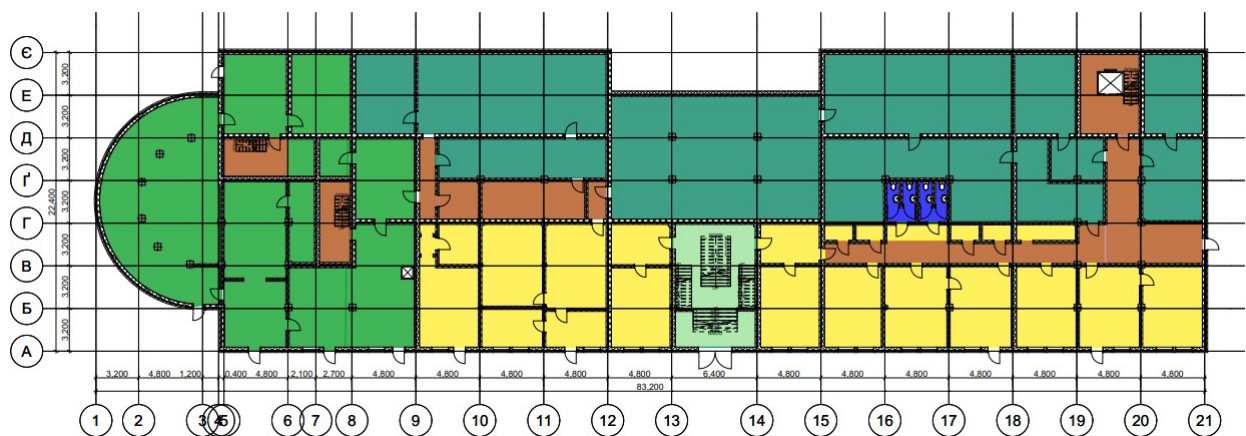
План 5 поверху з монтажем стінових конструкцій
